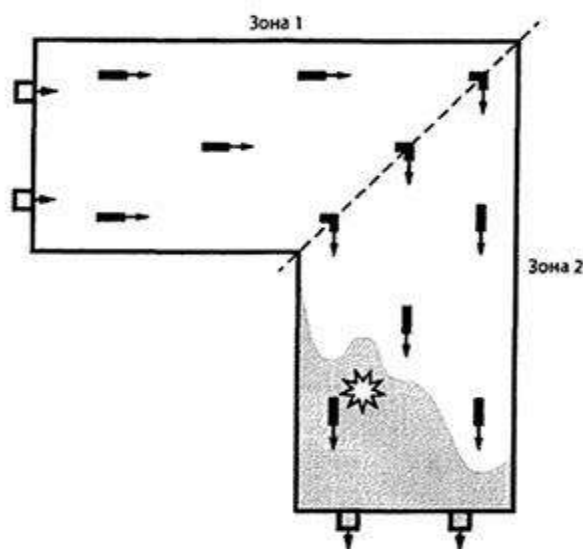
Схема автостоянки, оснащенной системой струйной вентиляции на базе центробежных струйных вентиляторов
